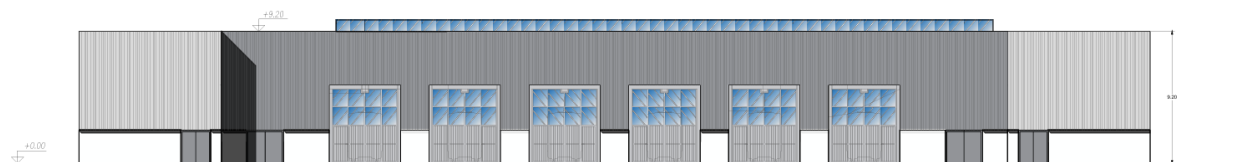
Officina manutenzione rotabili_ Prospetto nord
